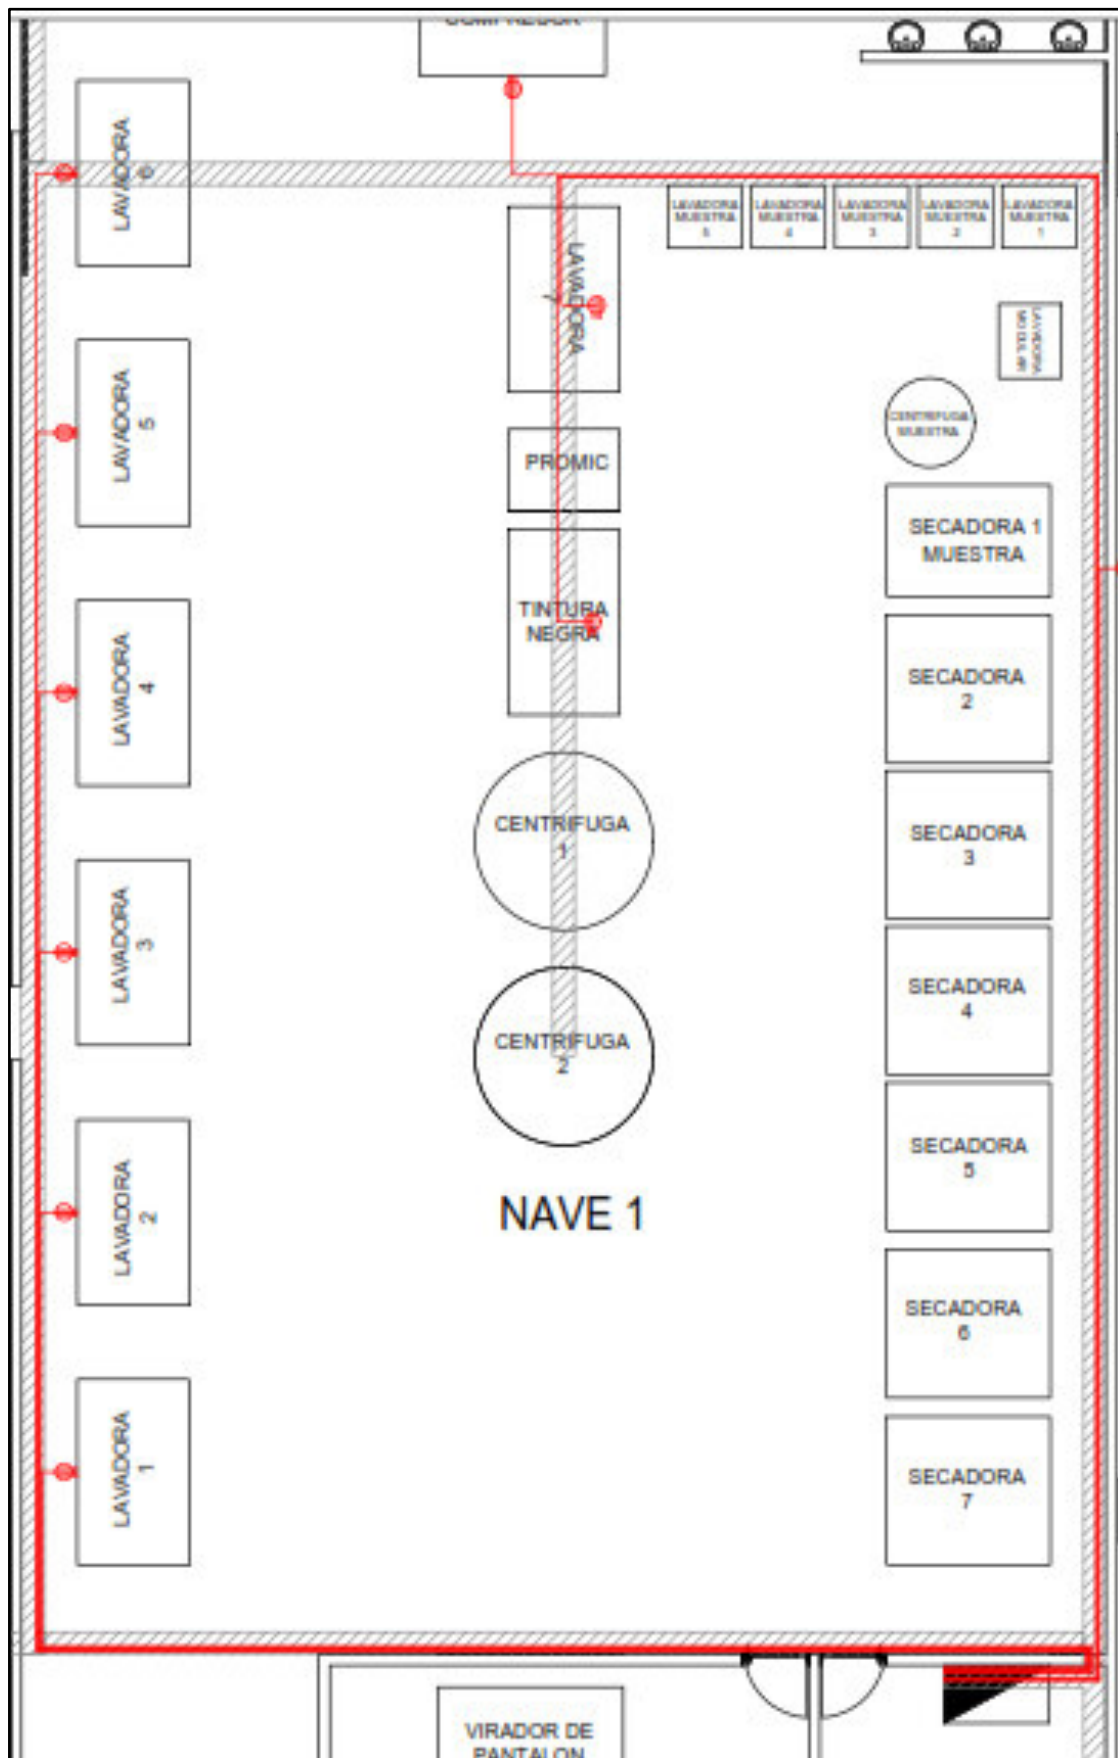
Imagen de plano de bajo voltaje (cable #6)
